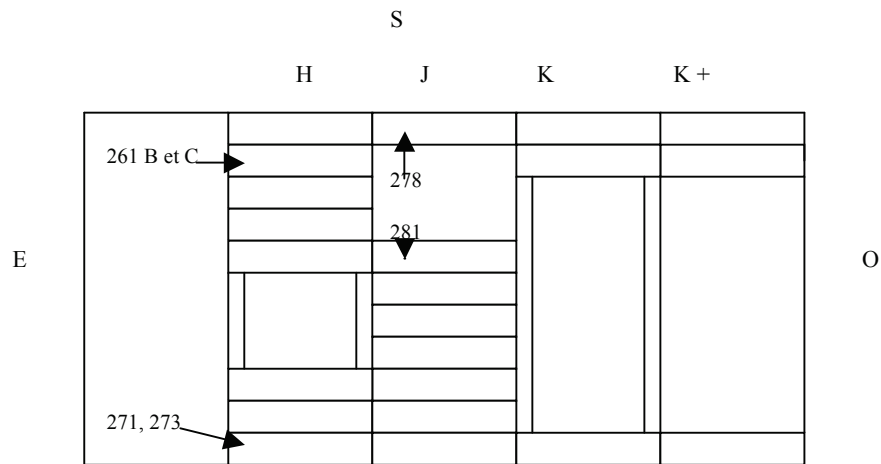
Plan clef du toit au-dessus de la Salle Hypostyle.
